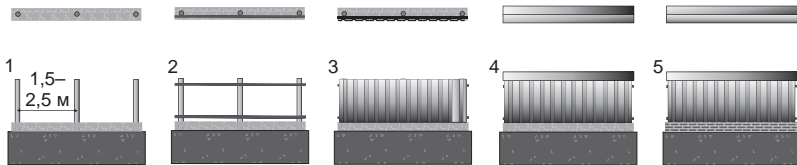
Сборка глухого ограждения стационарным методом монтажа: 1 — бетонирование стоек; 2 — монтаж прожилин; 3 — заполнение пролетов; 4 — монтаж козырька; 5 — отделка фундамента
